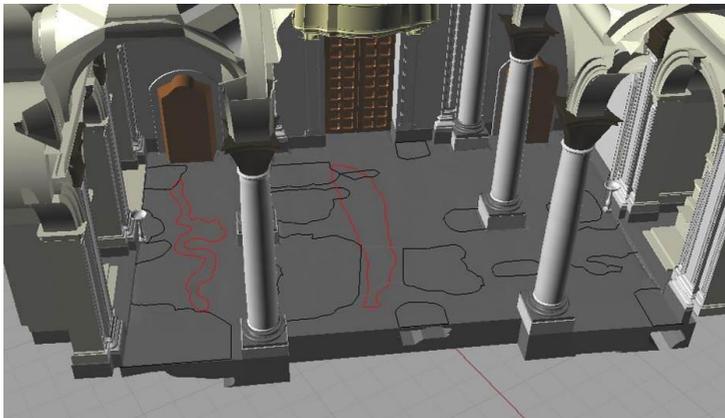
Proiezione delle sepolture sul pavimento, in grigio, e, in rosso, gli avvallamenti.
